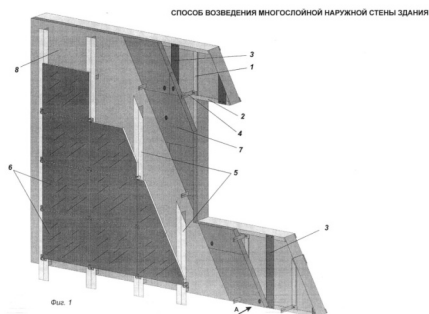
Общий вид наружной многослойной стены [4-5], где: 1- стойка; 2 – ригель; 3 – монтажные полосы; 4 – установочные кронштейны; 5 – вертикальные лаги; 6 – облицовочные плиты; 7 – плитный утеплитель; 8 – ветрозащитный слой.
